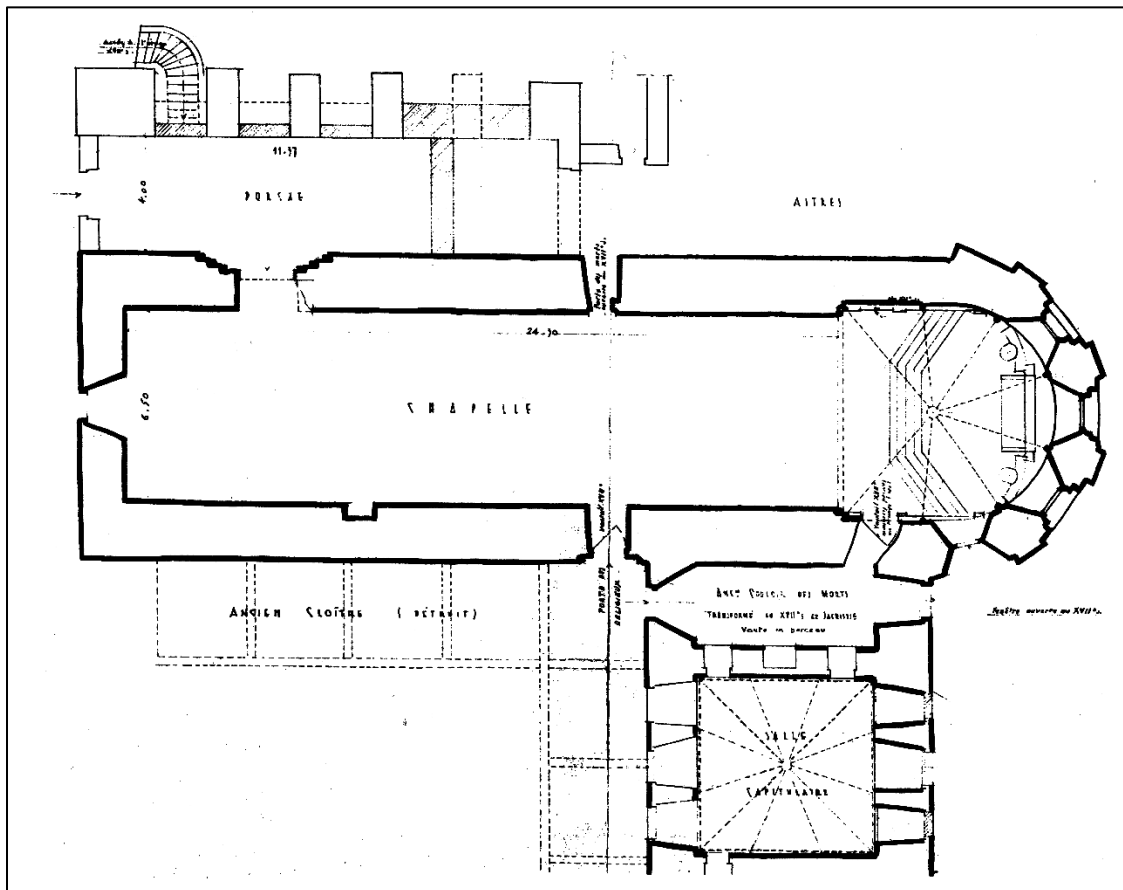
Cizay-la-Madeleine – Le Breuil-Bellay (Maine-et-Loire), Plan de l'église et de la salle capitulaire, d'après R. Baldet (Delaval, 1992 : 117).
